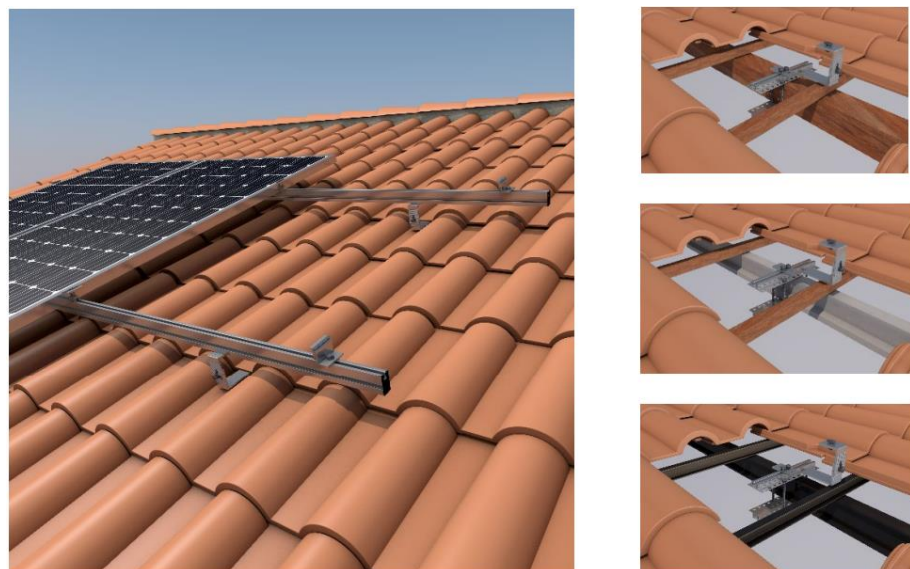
Estrutura de fixação dos painéis com recurso a varão roscado para placa de betão ou barrote de madeira (Sunfer Energy, 2023).
